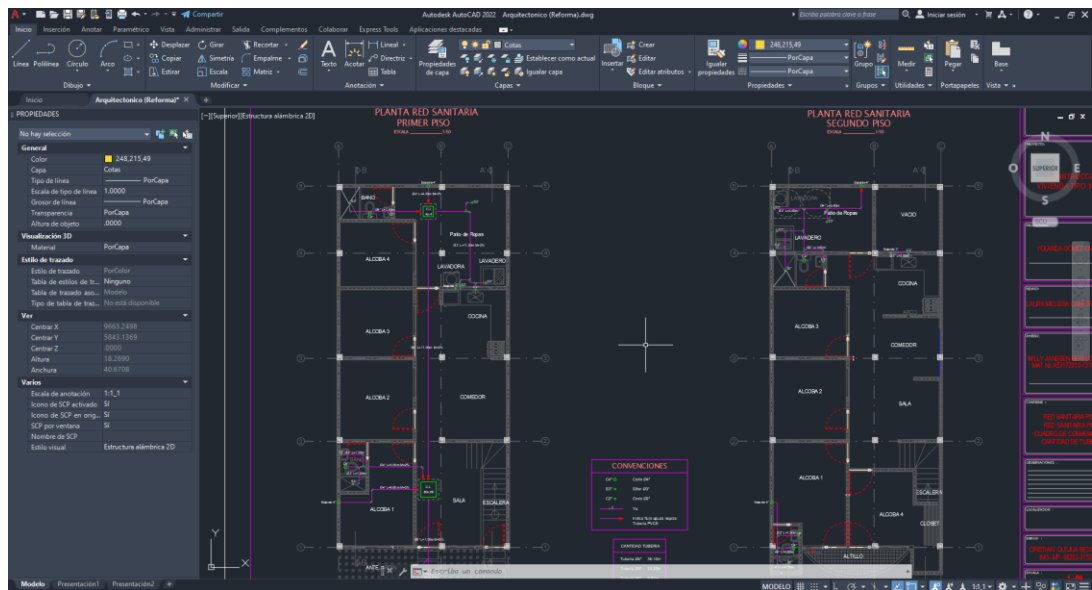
Plano sanitario. AutoCAD. Fuente elaboración propia.
